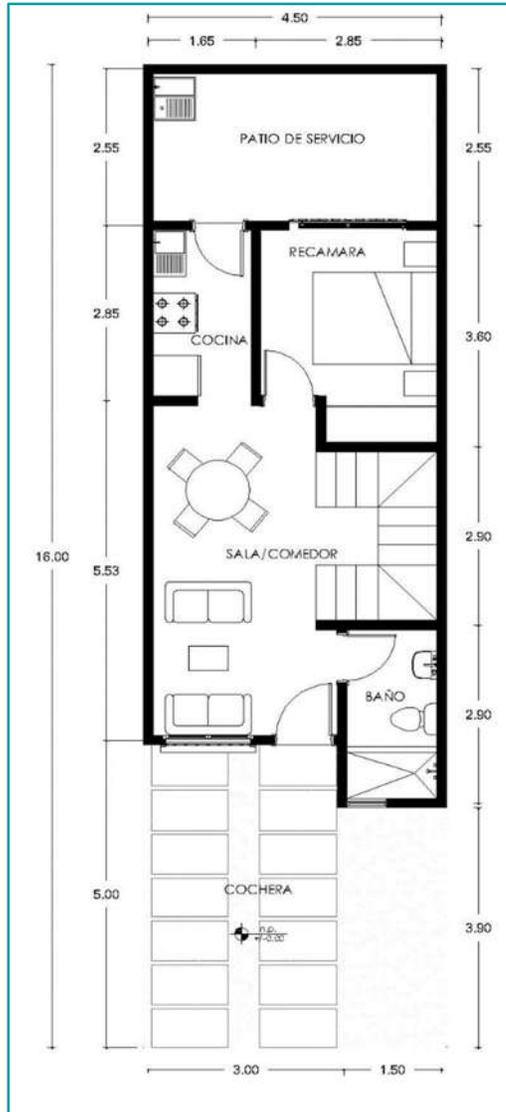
Planta de la vivienda con el mobiliario propuesto por el proveedor.
